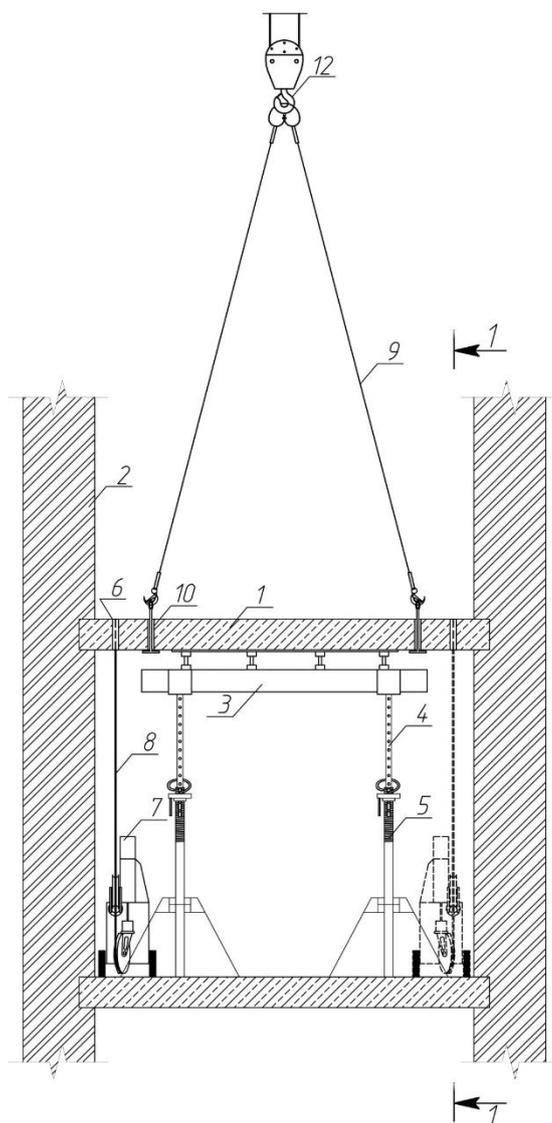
Схема резки железобетонного перекрытия алмазной канатной пилой с его поддомкрачиванием инвентарными балками и стойками опалубочной системы
